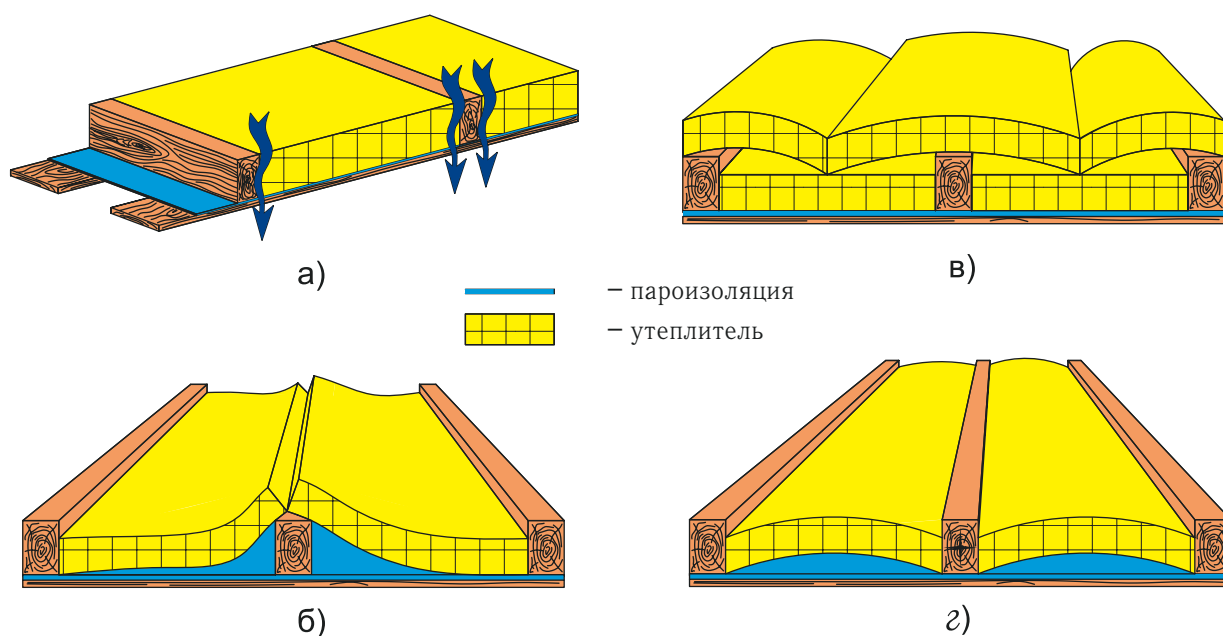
Типичные ошибки в укладке теплоизоляции
